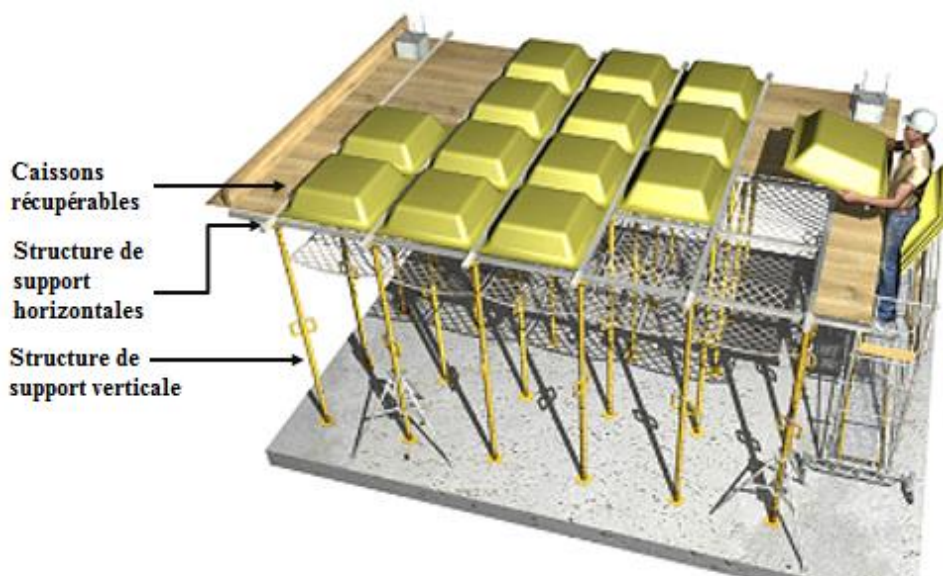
PRINCIPE DU COFFRAGE D'UNE DALLE RETICULEE A CAISSONS RECUPERABLES
